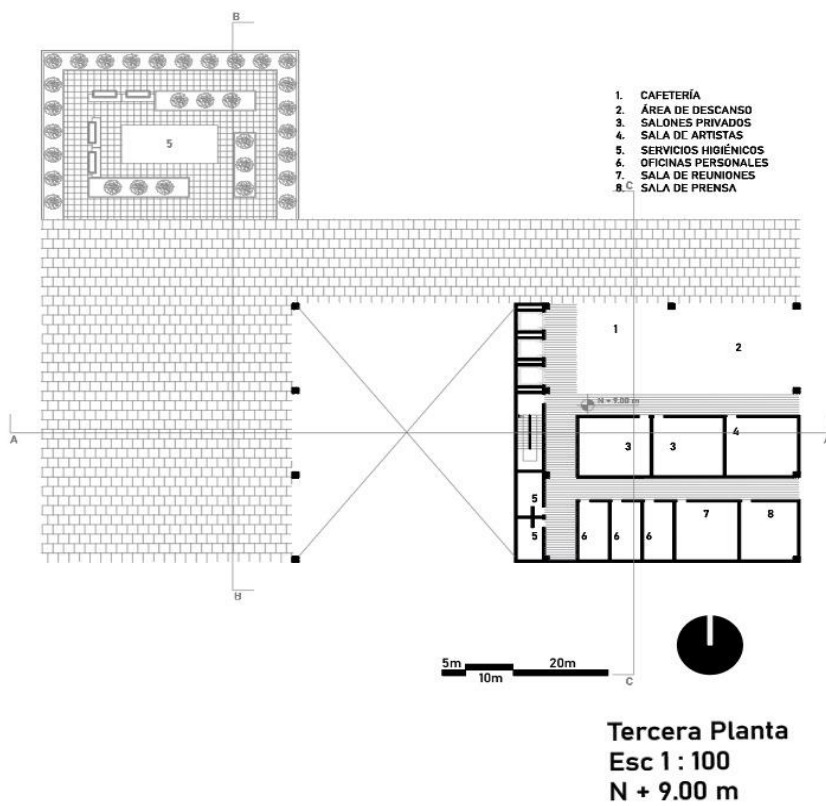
"Tercera Planta Entrega Final" elaboración propia
